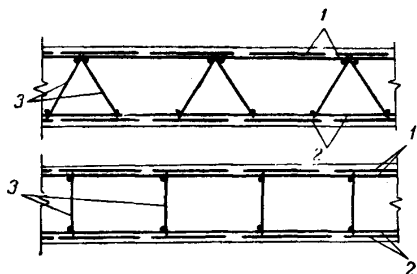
Армирование сплошных железобетонных плитных фундаментов сварными сетками и каркасами
